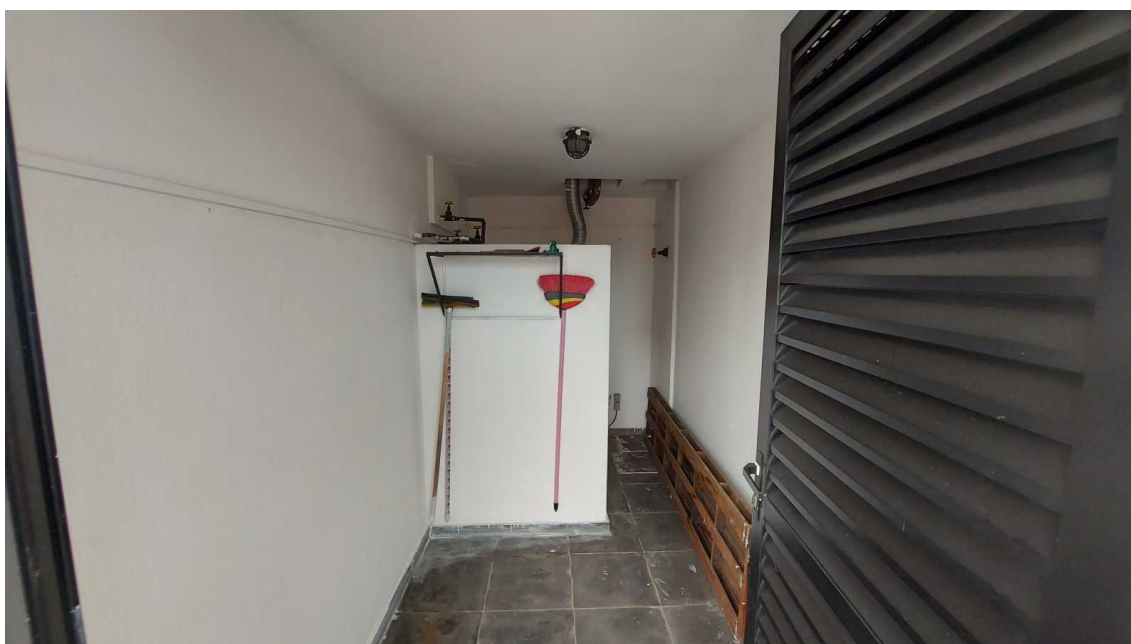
Sala de Manutenção – Área externa, pavimento Mezanino
